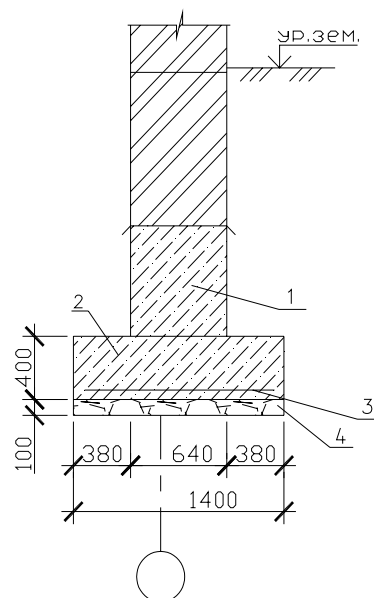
Конструкция усиления фундамента: 1 – существующий фундамент, 2 – вновь устраиваемая подушка ленточного фундамента, 3 – арматурная сетка из арматуры класса А-III, d=10мм, шаг 150мм, 4 – подготовка под фундамент, из втрамбованного в грунт гравия
